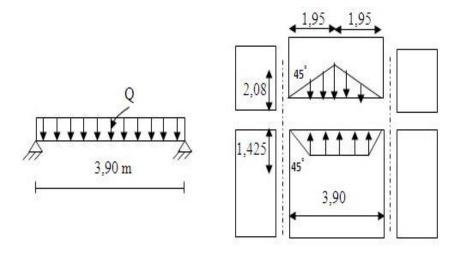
Répartition des charges sur les poutres selon les lignes de rupture.
